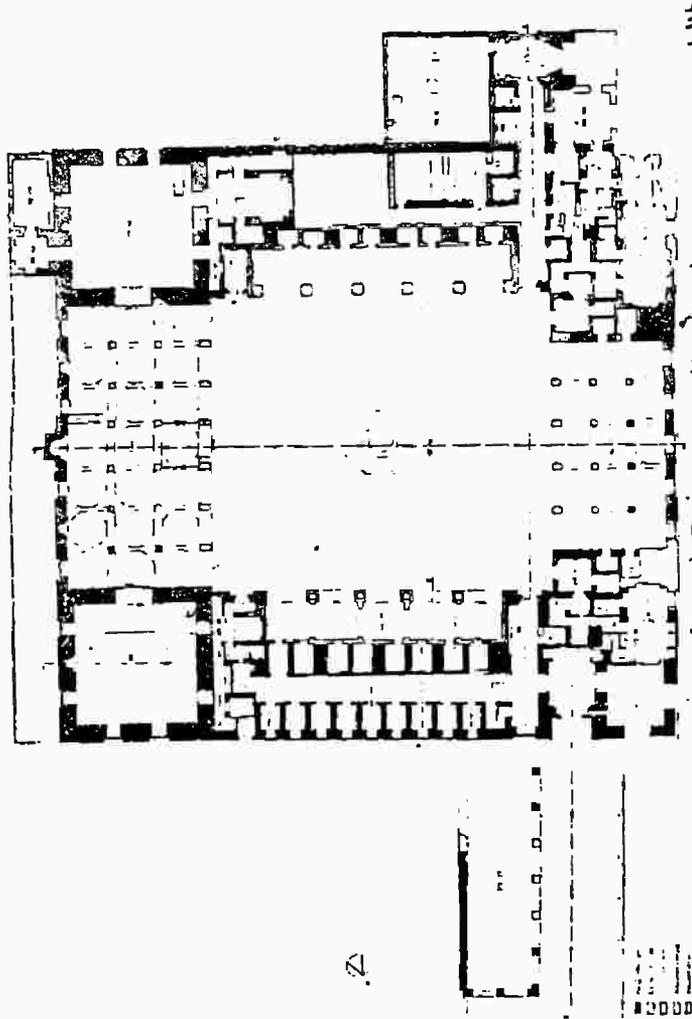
مسقط أفقي لقبة خوند طوليه
